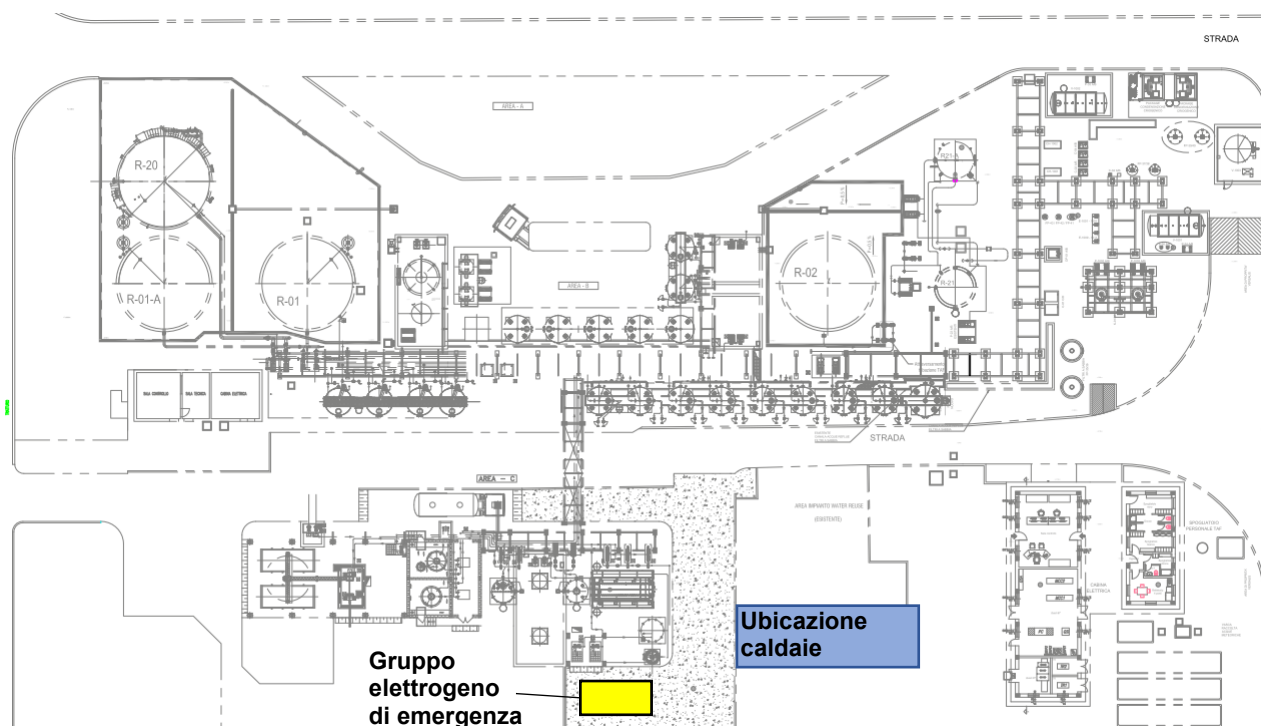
Ubicazione delle caldaie, in blu, e del gruppo elettrogeno di emergenza, in giallo, rispetto alla planimetria dell'impianto TAF.
